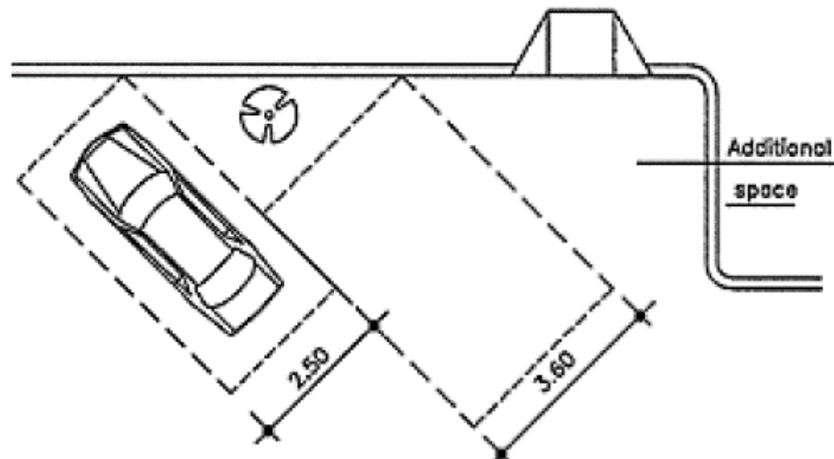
Lebar Minimum Parkir Aksesibel
